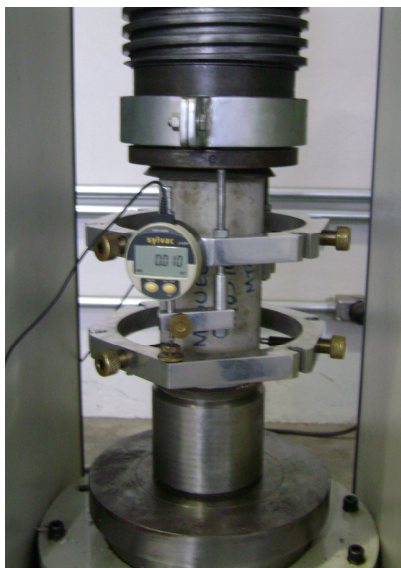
Equipamento utilizado no ensaio de módulo de deformação.
